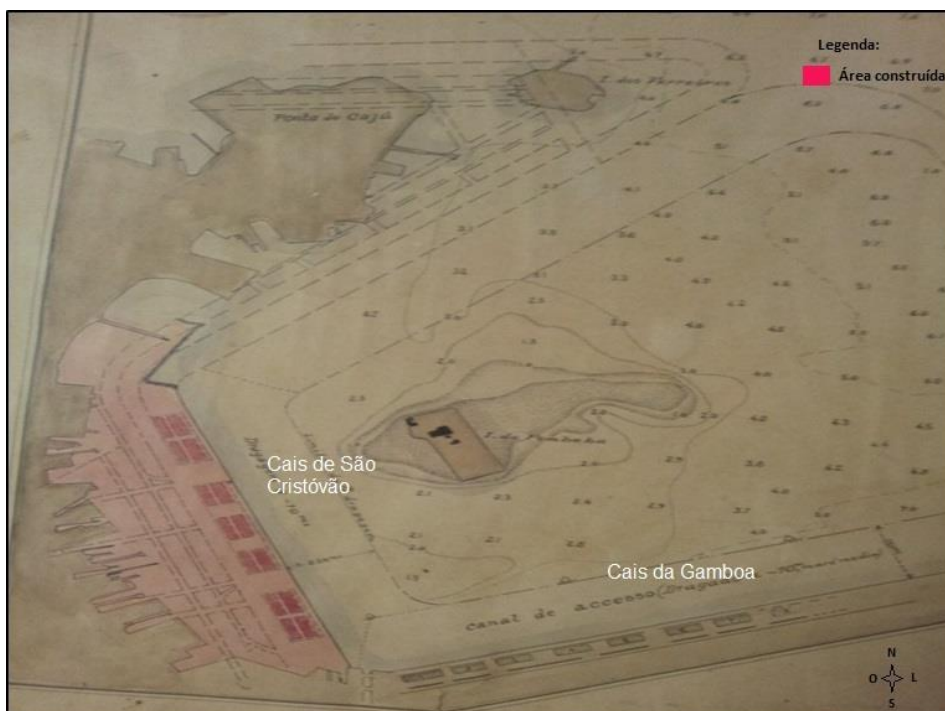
Planta da configuração final das obras realizadas no porto em 1924, Rio de Janeiro - RJ
